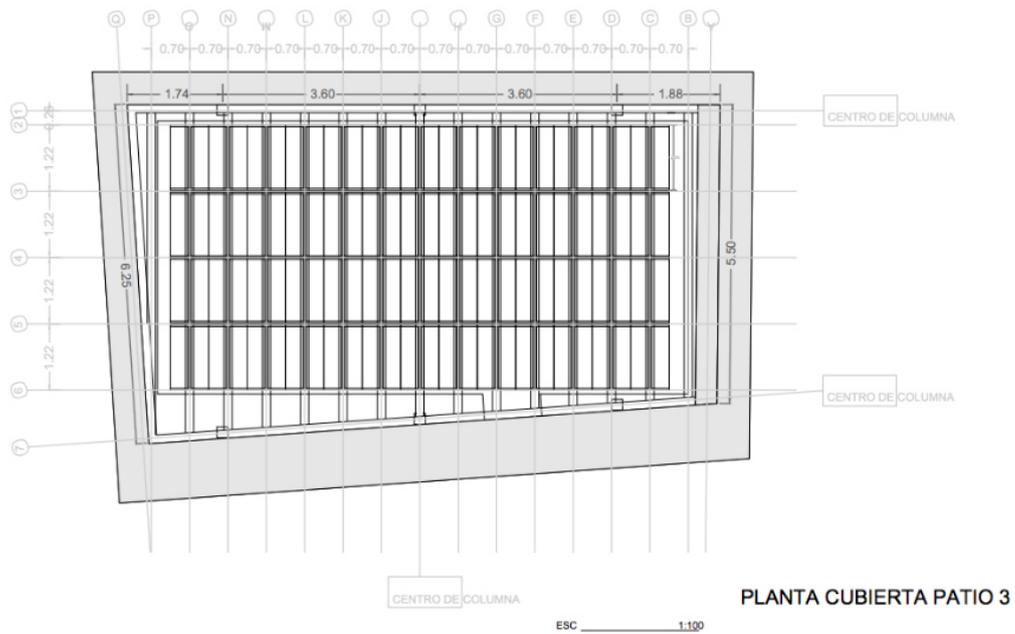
Planos técnicos planta cubierta – Casa del Alabado
